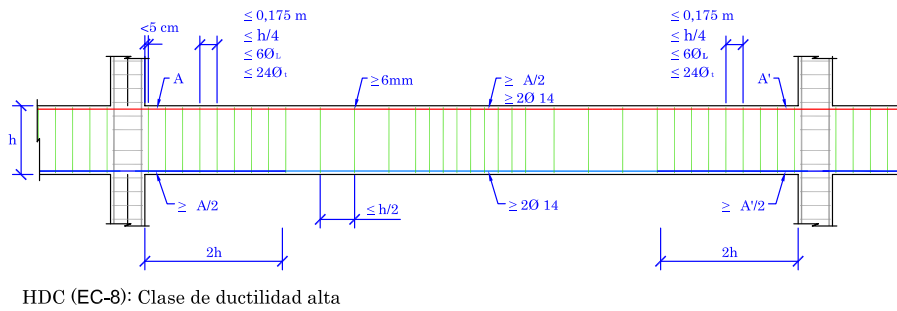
Recomendaciones de armado de vigas según el EC-8 para ductilidad alta
